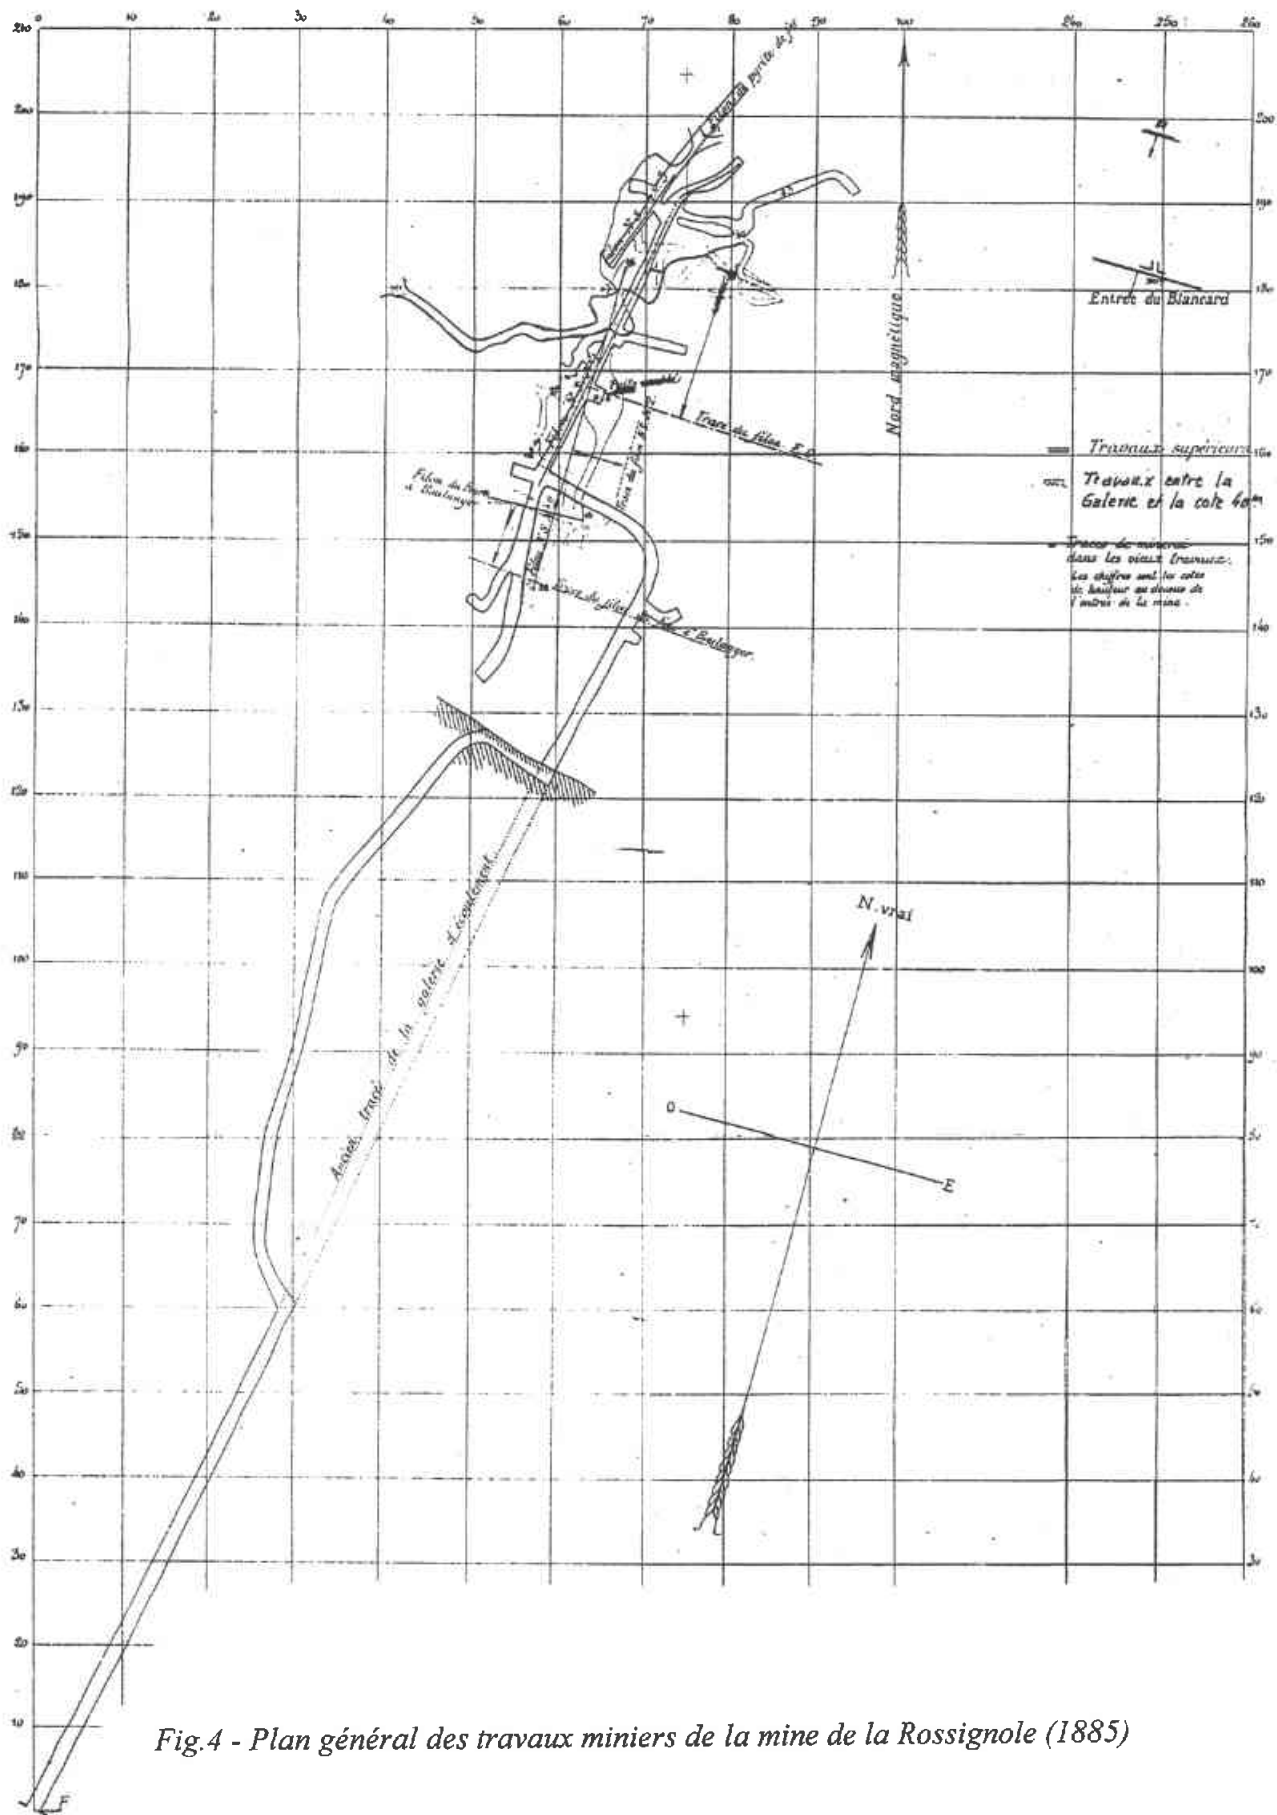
Plan général des travaux miniers de la mine de la Rossignole (1885)
